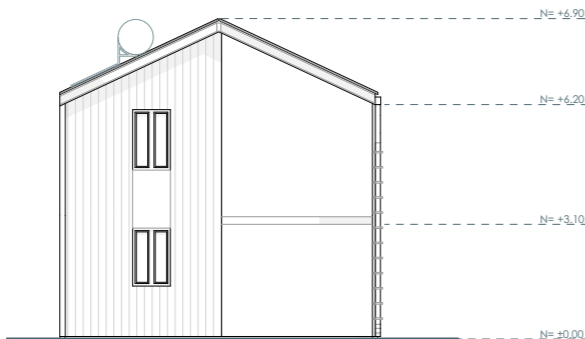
Elevación frontal Villa Verde. Fuente: Autores, 2023
